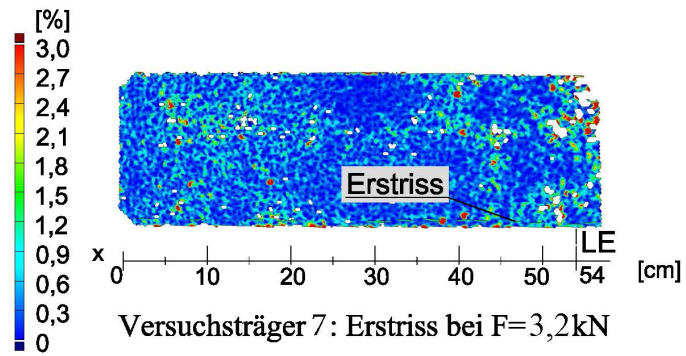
Versuchsträger 7- Lage Erstriss
